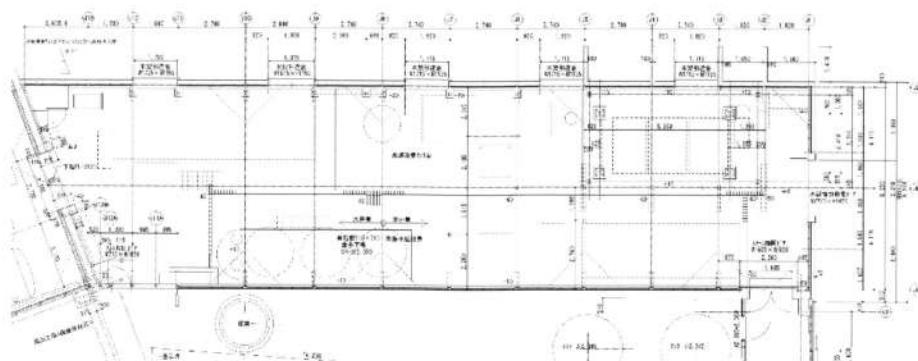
貯蔵庫(蒸溜受タンク室)平面図 (株式会社シン技術コンサル提供)
